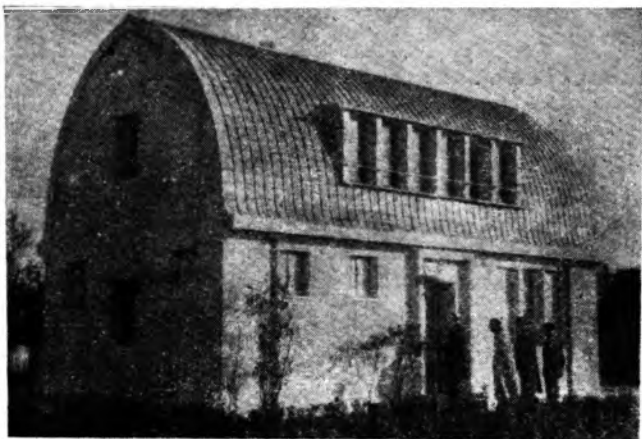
Jeden z prefabrykowanych domków eksperymentalnej kolonii mieszkaniowej w Noisy-le-Sec pod Paryżem. Konstrukcja domu z płyt żelbetowych, konstrukcja pierwszego piętra (poddasza) drewniana, wykończenie wewnętrzne w płytach pilśniowych. Pokrycie dachu — blacha cynkowa miedziowana. Oryginalny kształt dachu uwarunkowany zastosowaniem konstrukcji deskowej (rombowo-ostrołukowej).
